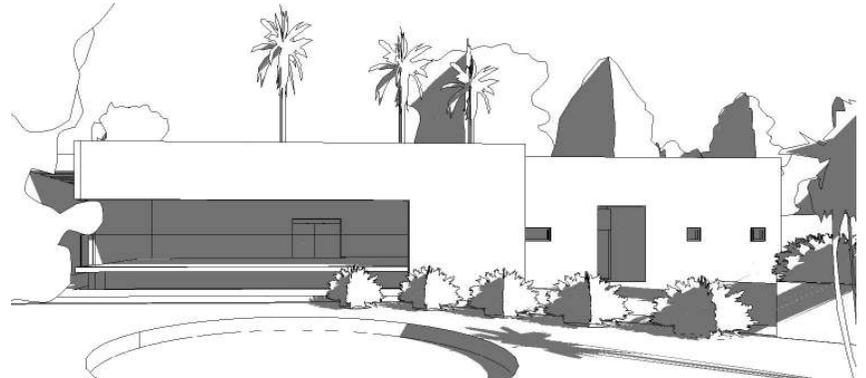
Comedor para trabajadores ubicado en el Módulo visto desde el patio de maniobras
